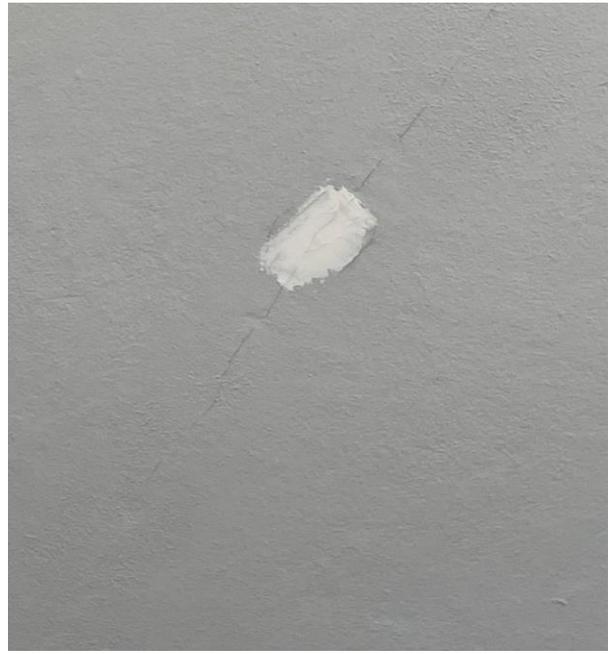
Apartamento 404 e do bloco A – Fissuras ativas rompendo o gesso.
